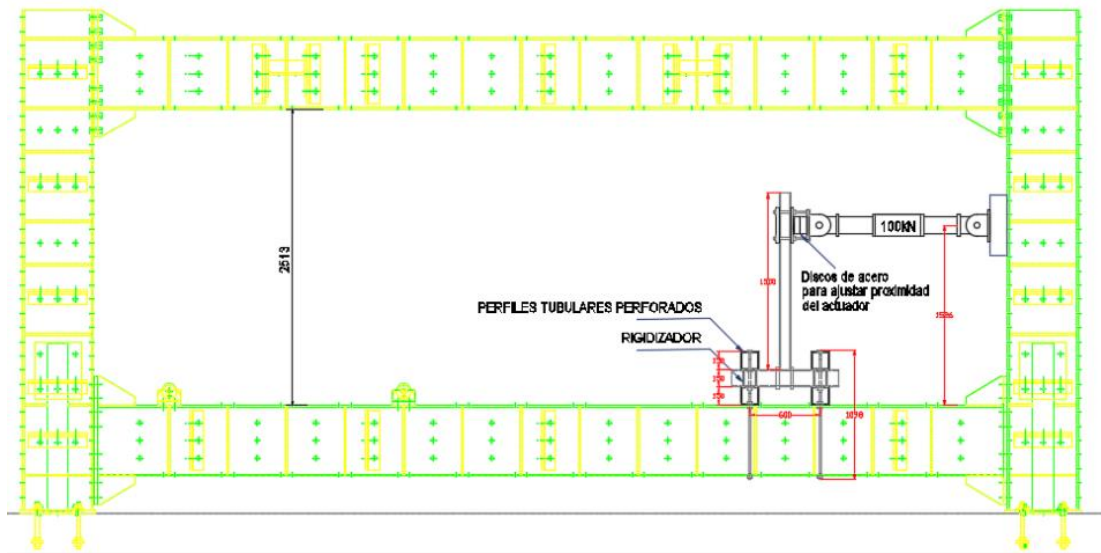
Plano de montaje de actuador para ensayo de la conexión– Plano de pórtico tomado de Estahl Ingeniería con modificaciones propias
